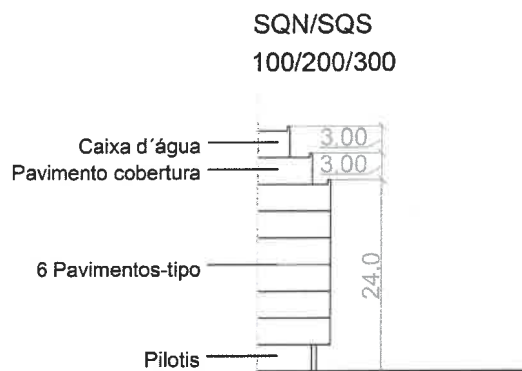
Proposta de alturas para edifício de superquadra (SQN/SQS 100/200/300): corte esquemático
